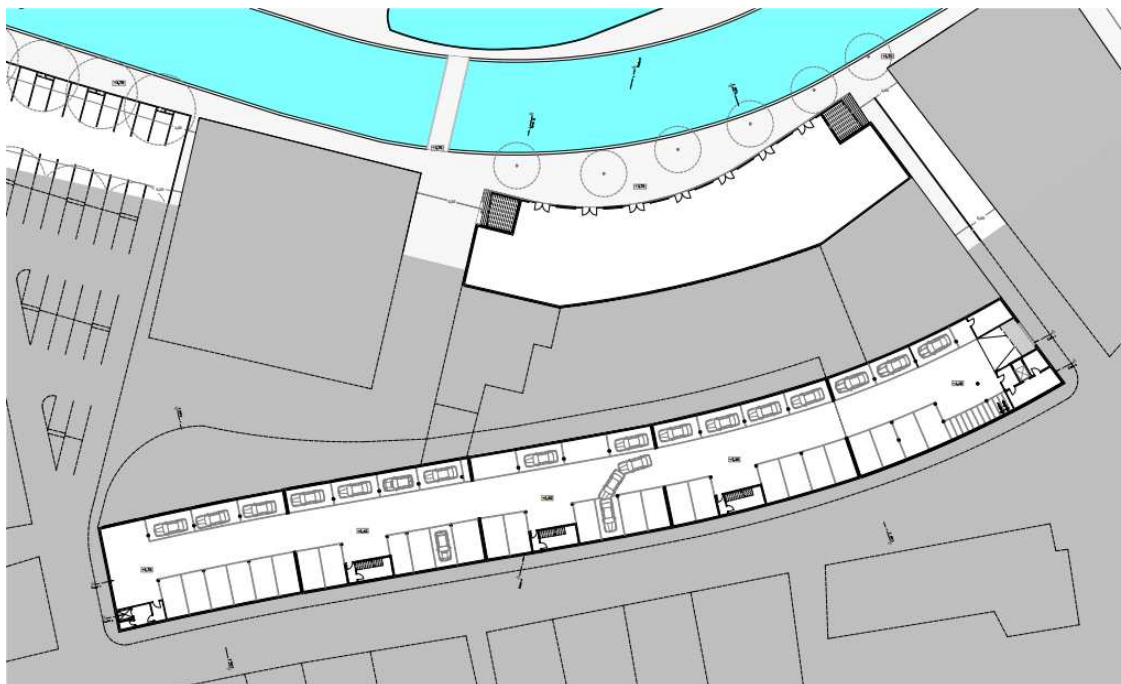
Painel final n.º2 - Habitação colectiva para jovens – Planta da cave
